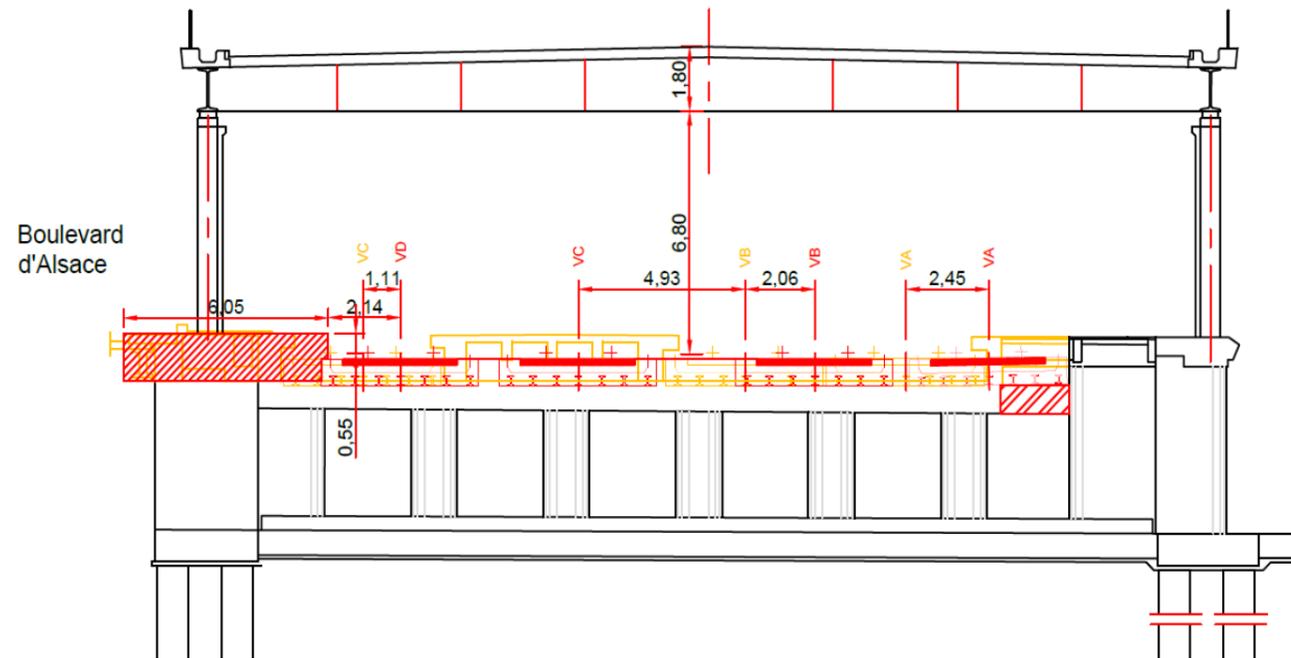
Coupe du pont-rail du passage Châteaudun (Systra, 2021)
